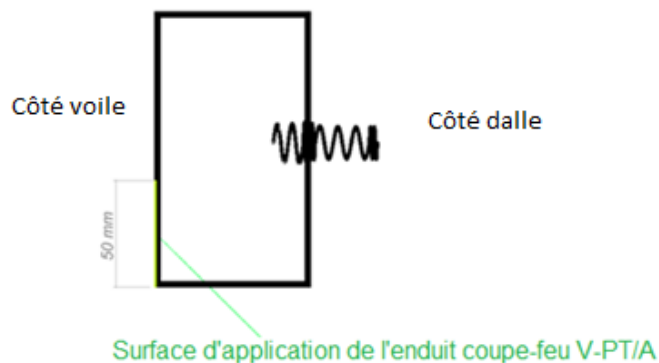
Mise en œuvre de l'enduit coupe-feu V-PT/A (Coupe au droit de la bande isolante)
